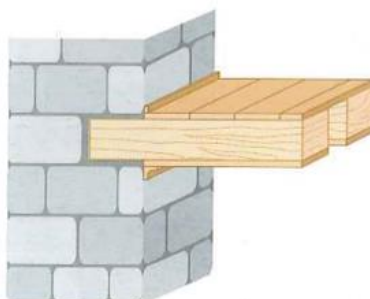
Representação esquemática de uma ligação pavimento/parede através do encastramento de vigas diretamente na parede (Appleton, 2003).
